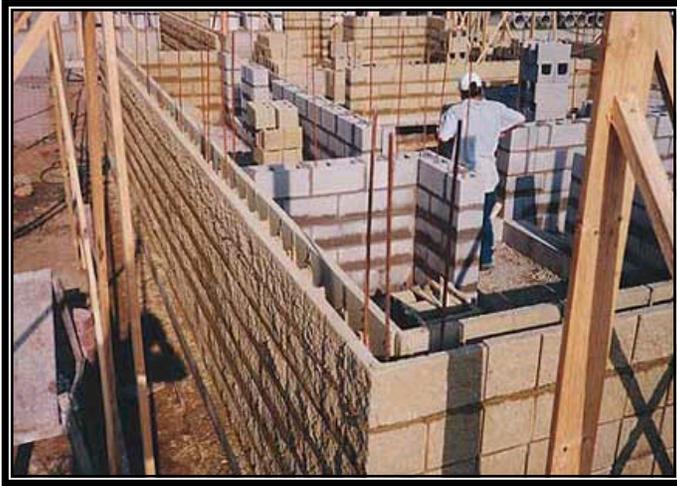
Modo de instalación de los bloques de hormigón coloreados.
